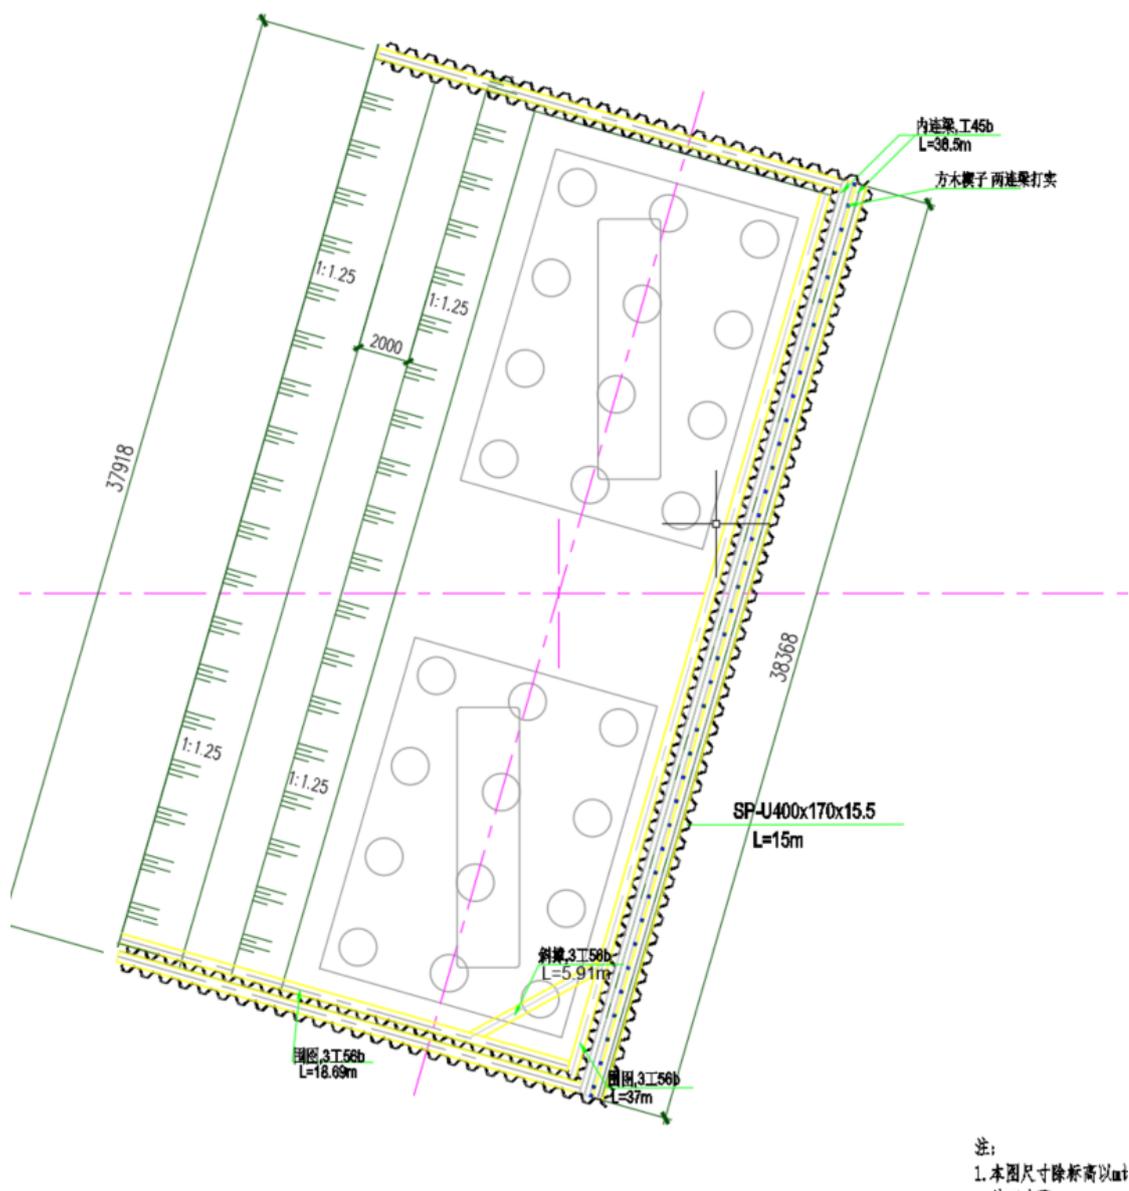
三侧钢板桩围檩支撑平面图
